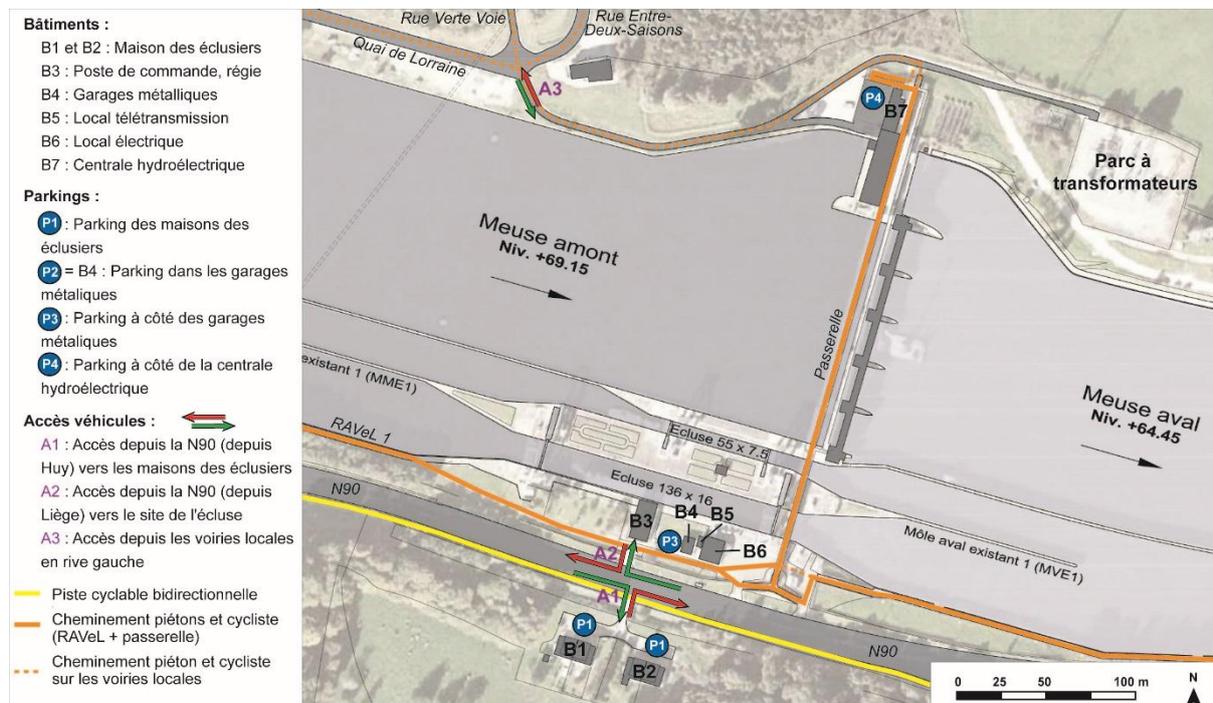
Accessibilité du site et stationnement (source : plan terrier de la situation existante - Greisch)
